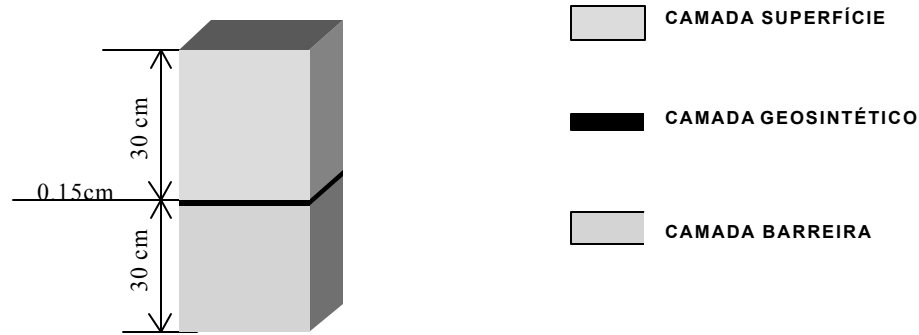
Perfil esquemático do sistema de cobertura SCC.
